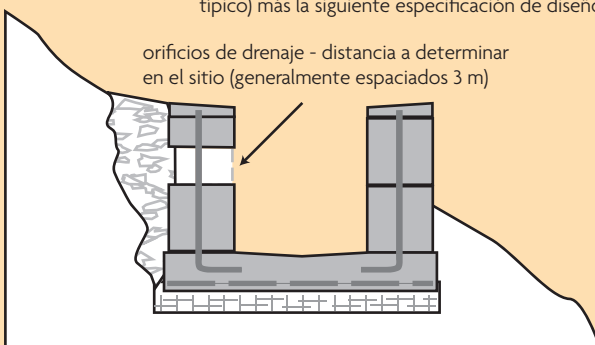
Ejemplo del diseño de un drenaje de bloque de hormigón
